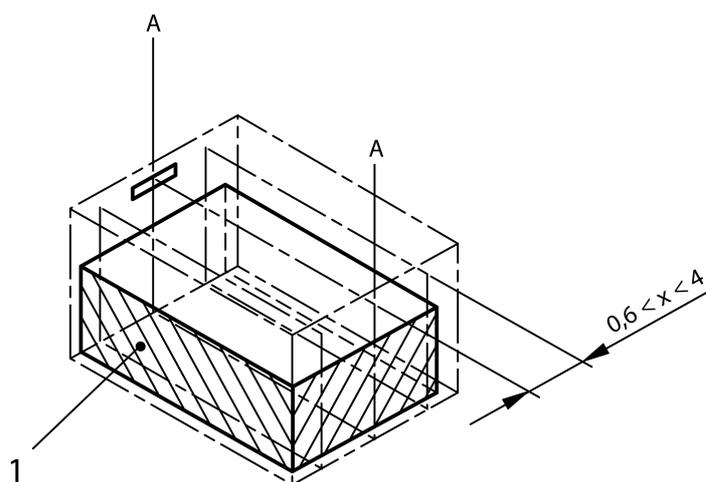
Diffuseur mural – Exemple de plans d'essai
